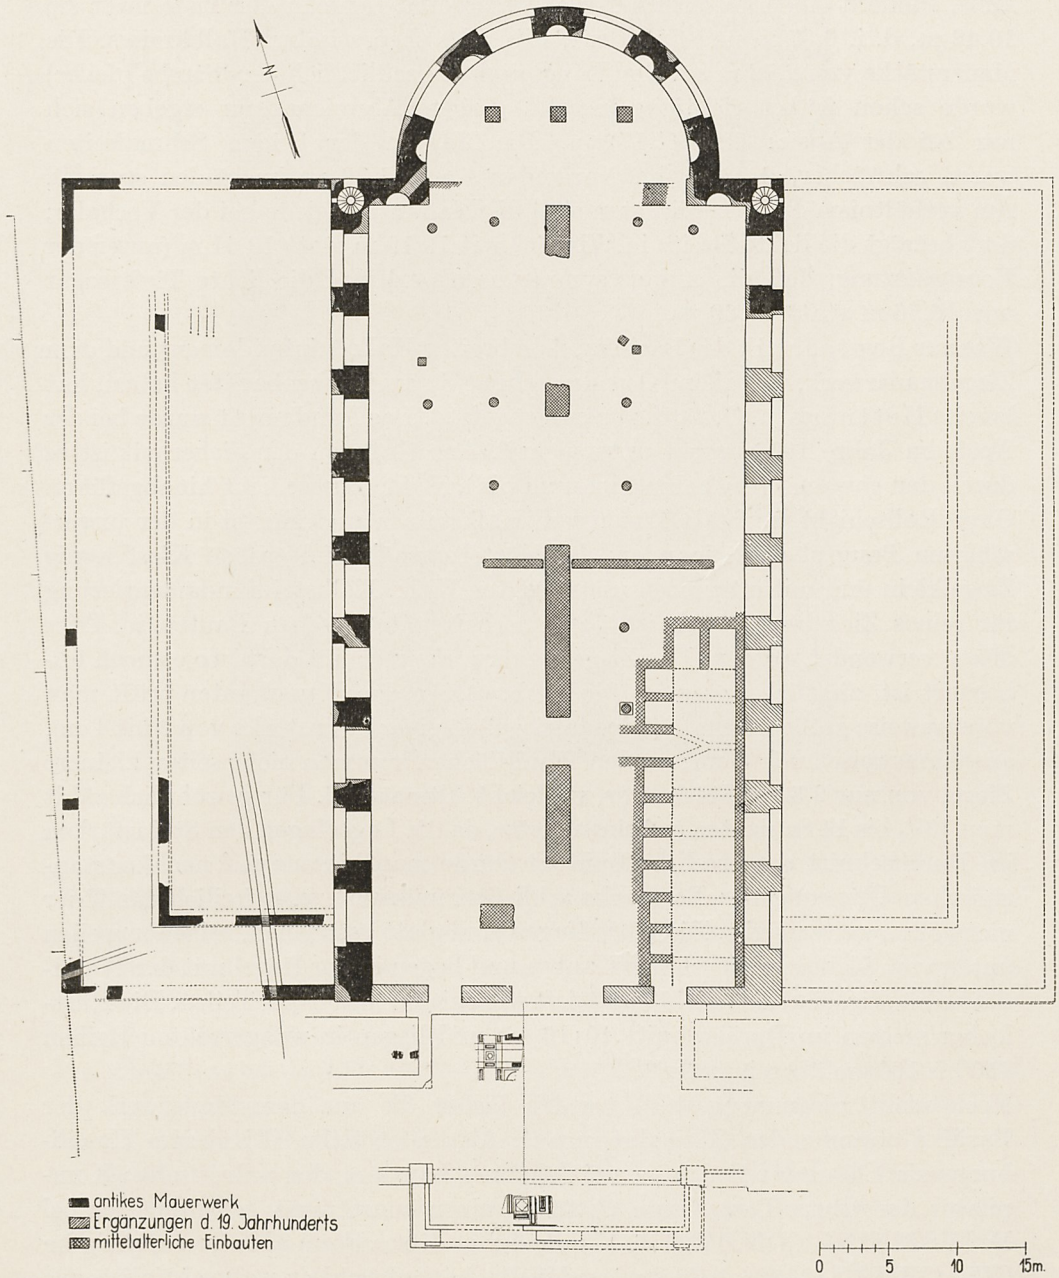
Basilika. Grundriß (nach dem Stand der Untersuchungen bis 1936).
